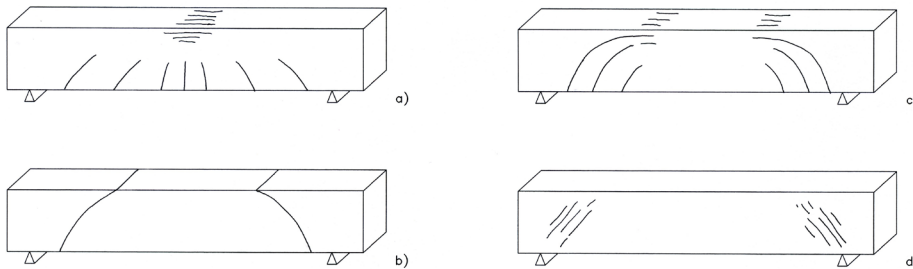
Formas que adoptan las grietas en una viga de hormigón armado apoyada en sus extremos, sometida a cargas verticales repartidas.
